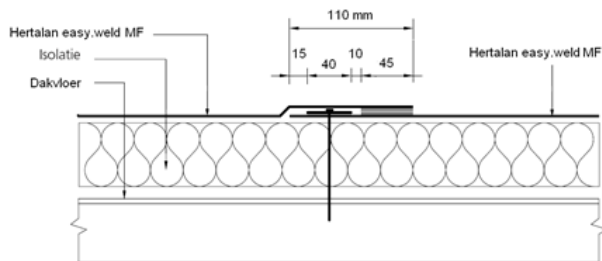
Langsnaad HERTALAN EASY WELD
